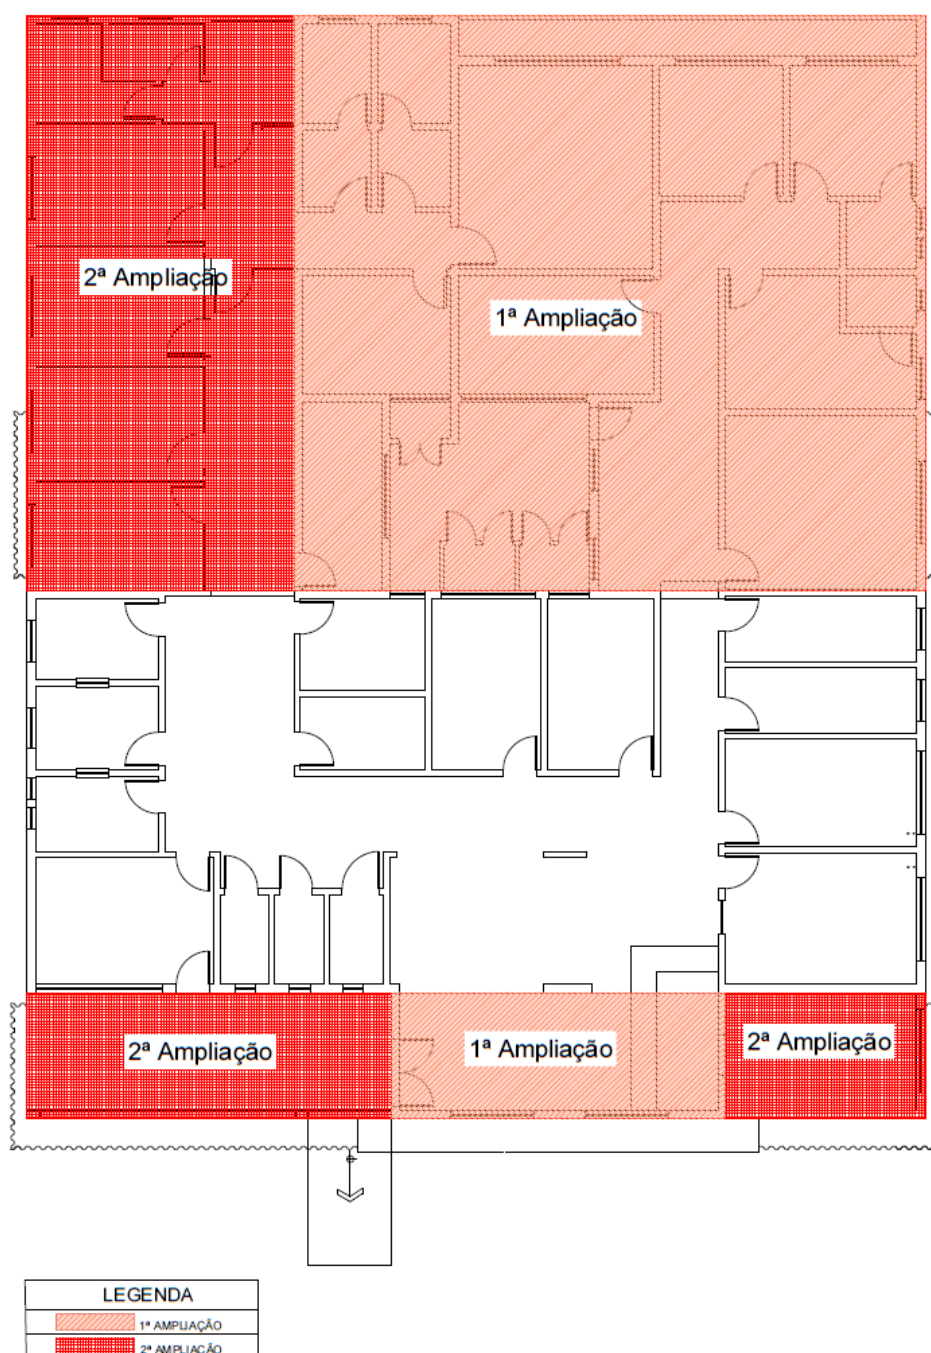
Planta baixa da UBS Costa e Silva com as áreas a construir e demolir
